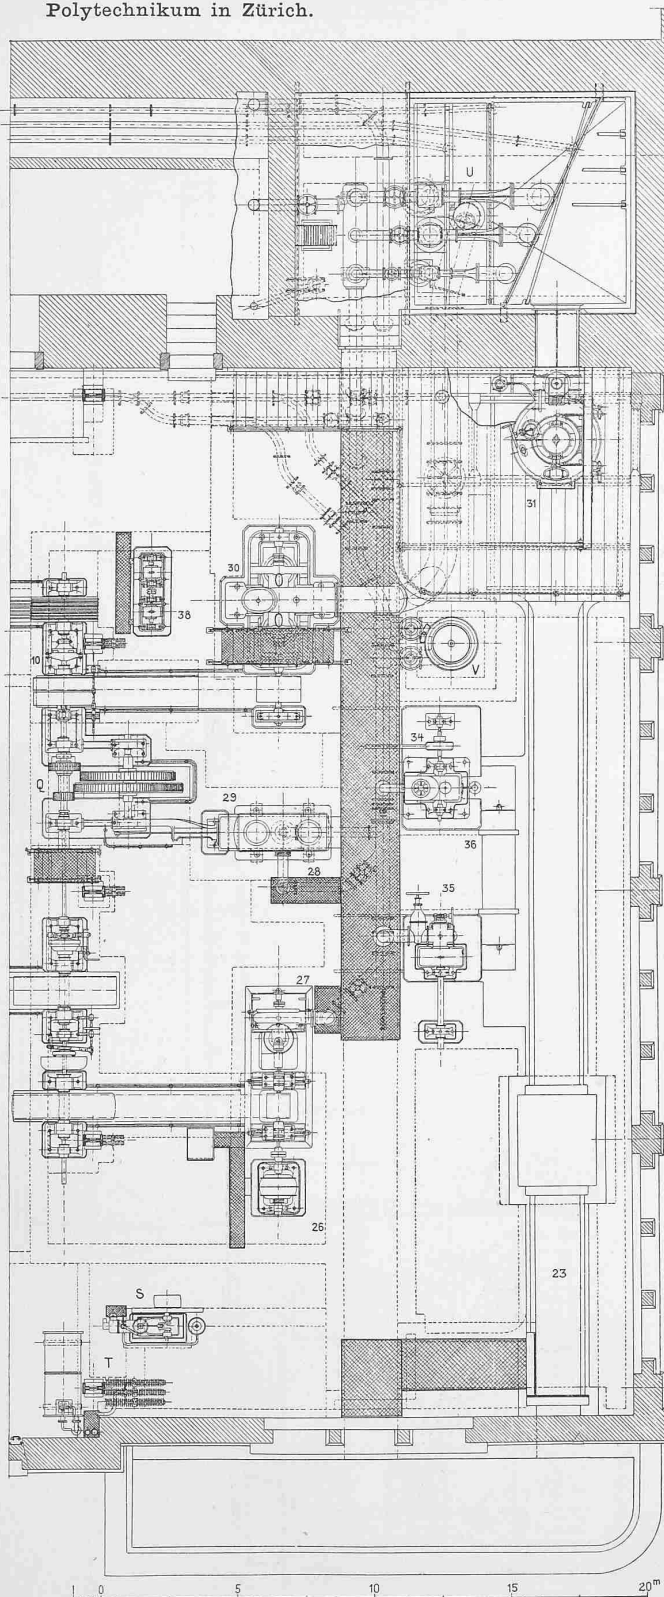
Grundriss der Maschinenhalle, südlicher Teil. 1:250.
